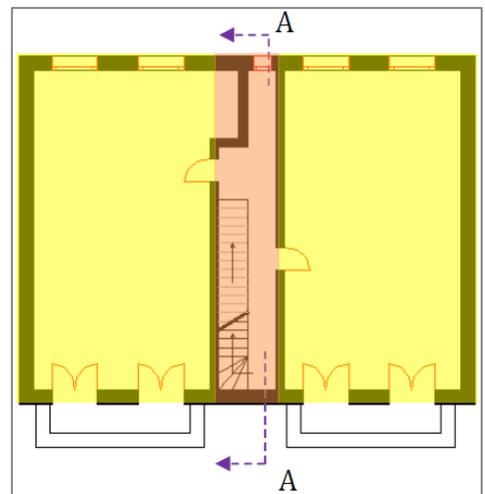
Plan étage courant (sous-sols et 1er étage)
